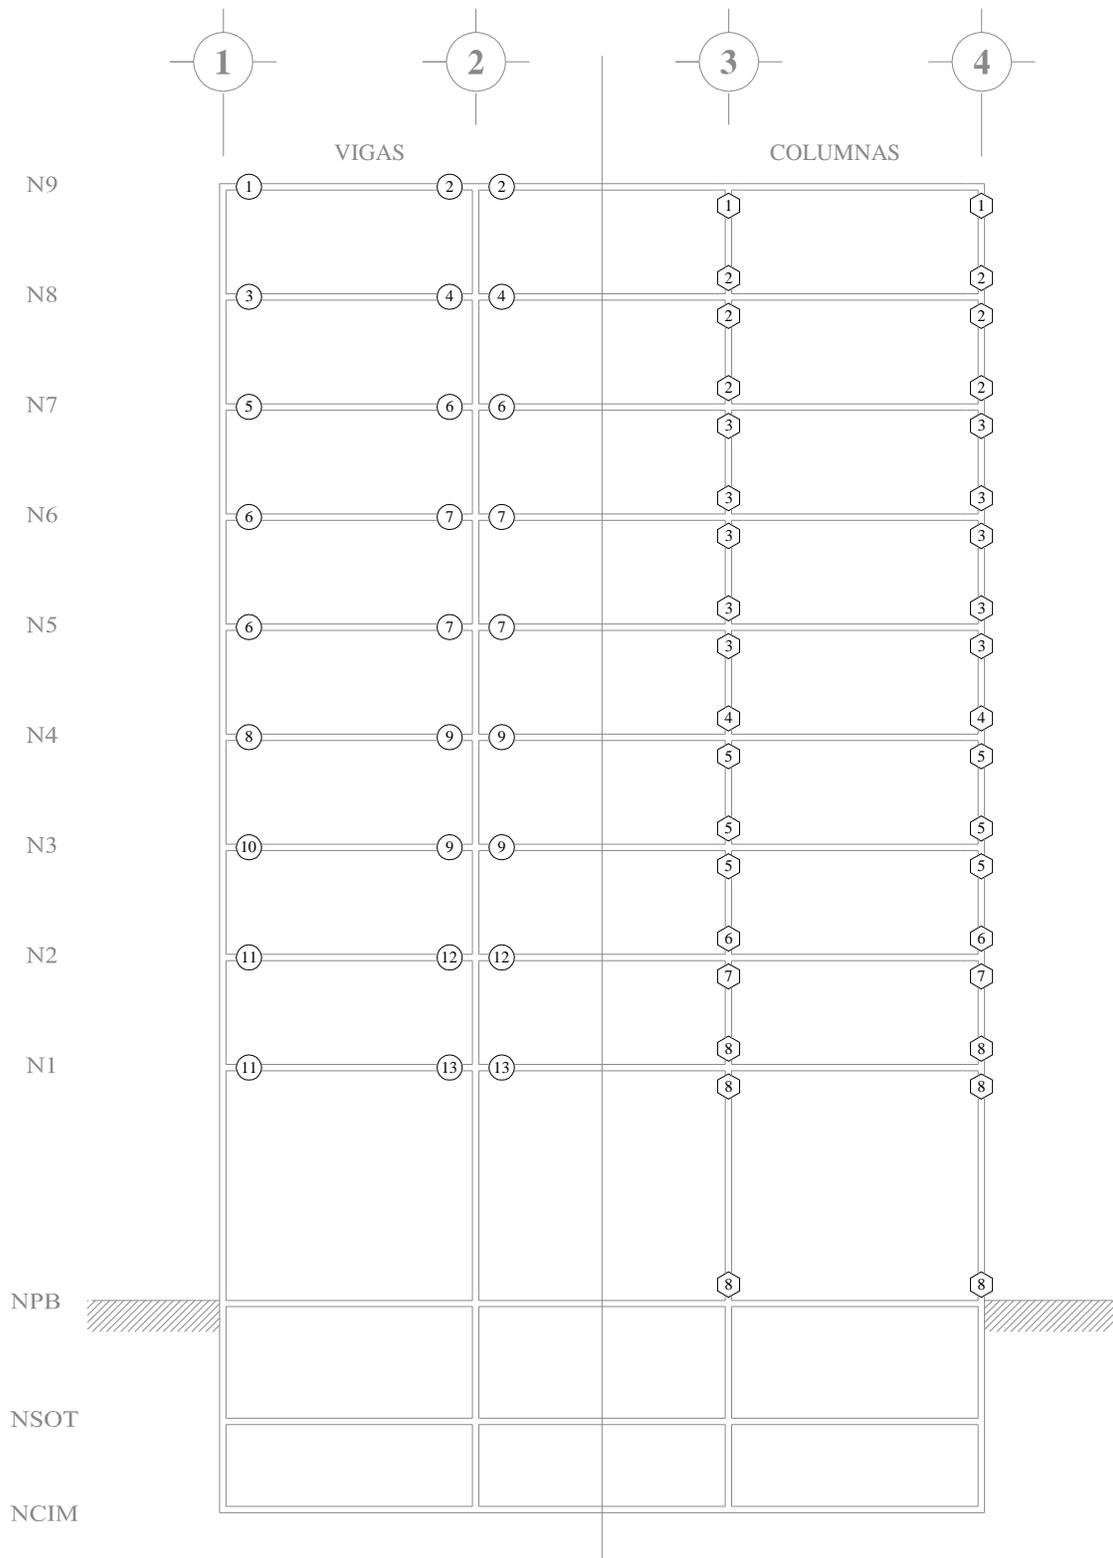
Ubicación de tipos de armados de vigas y columnas del eje C, edificio 9 niveles, Apéndice A de las NTC-Sismo, RDF-04
